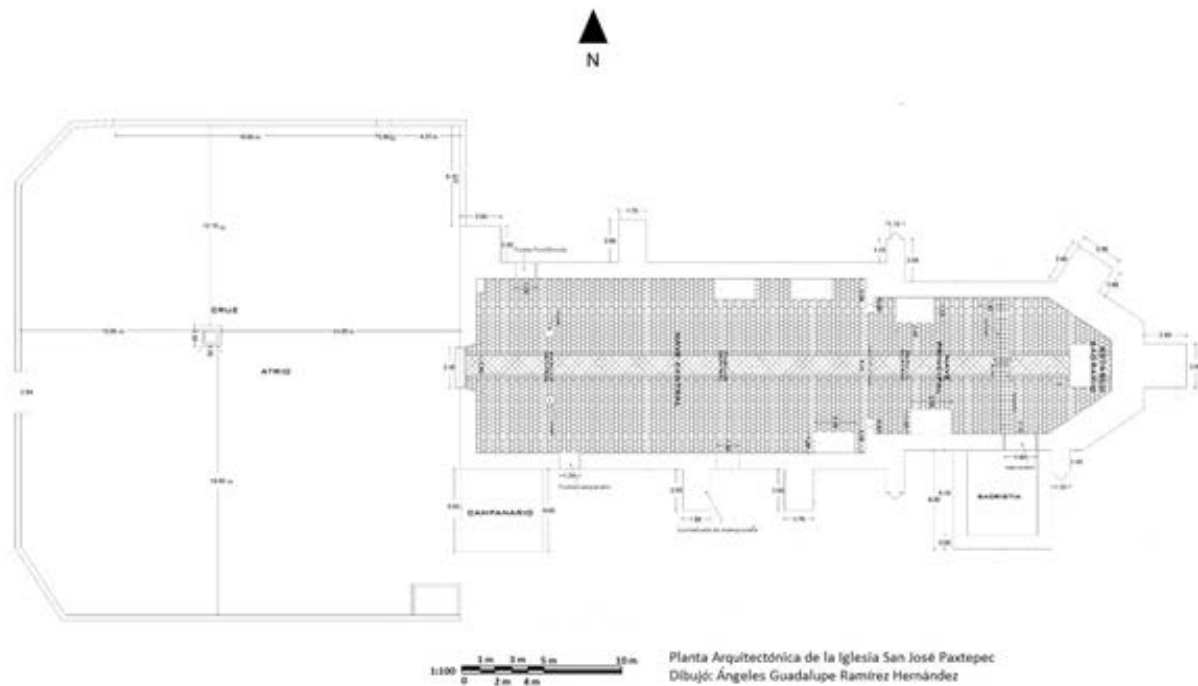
Planta Arquitectónica de la Iglesia San José Paxtepec.
